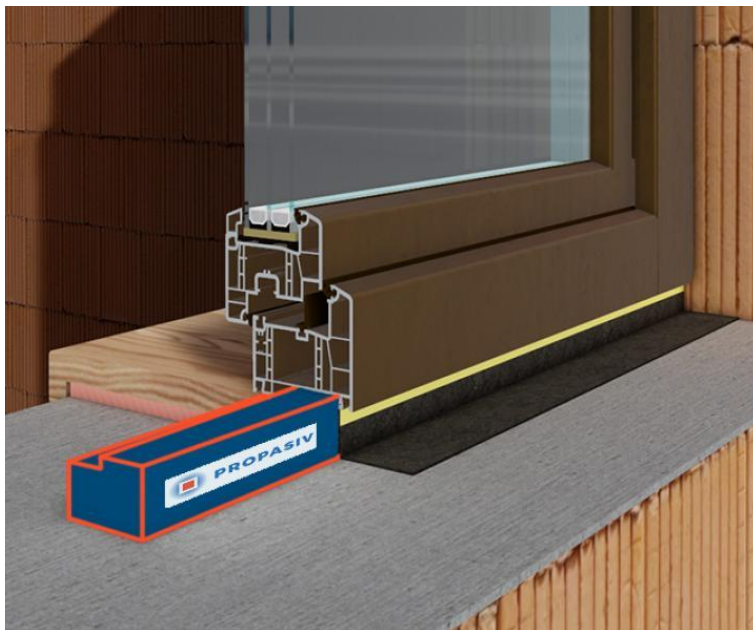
Vizualizace principu osazení hranolů pro předsazenou montáž běžného okna u systému PROPASIV [Zdroj: <https://www.propasiv.cz/technicka-dokumentace/>]
